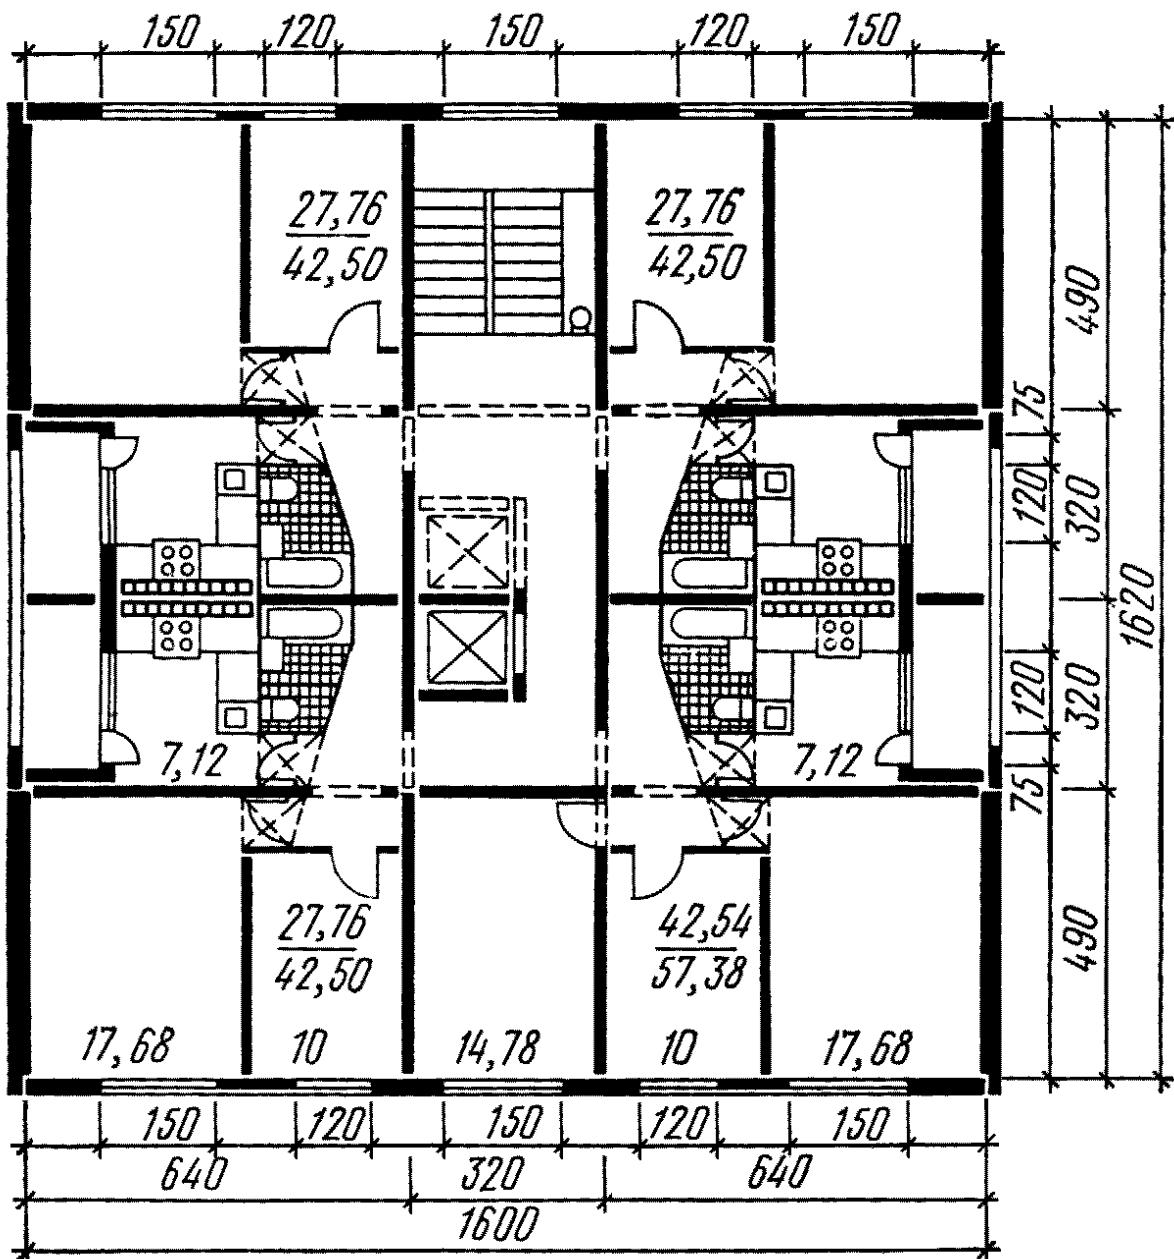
План типового этажа 9-этажного односекционного жилого дома
